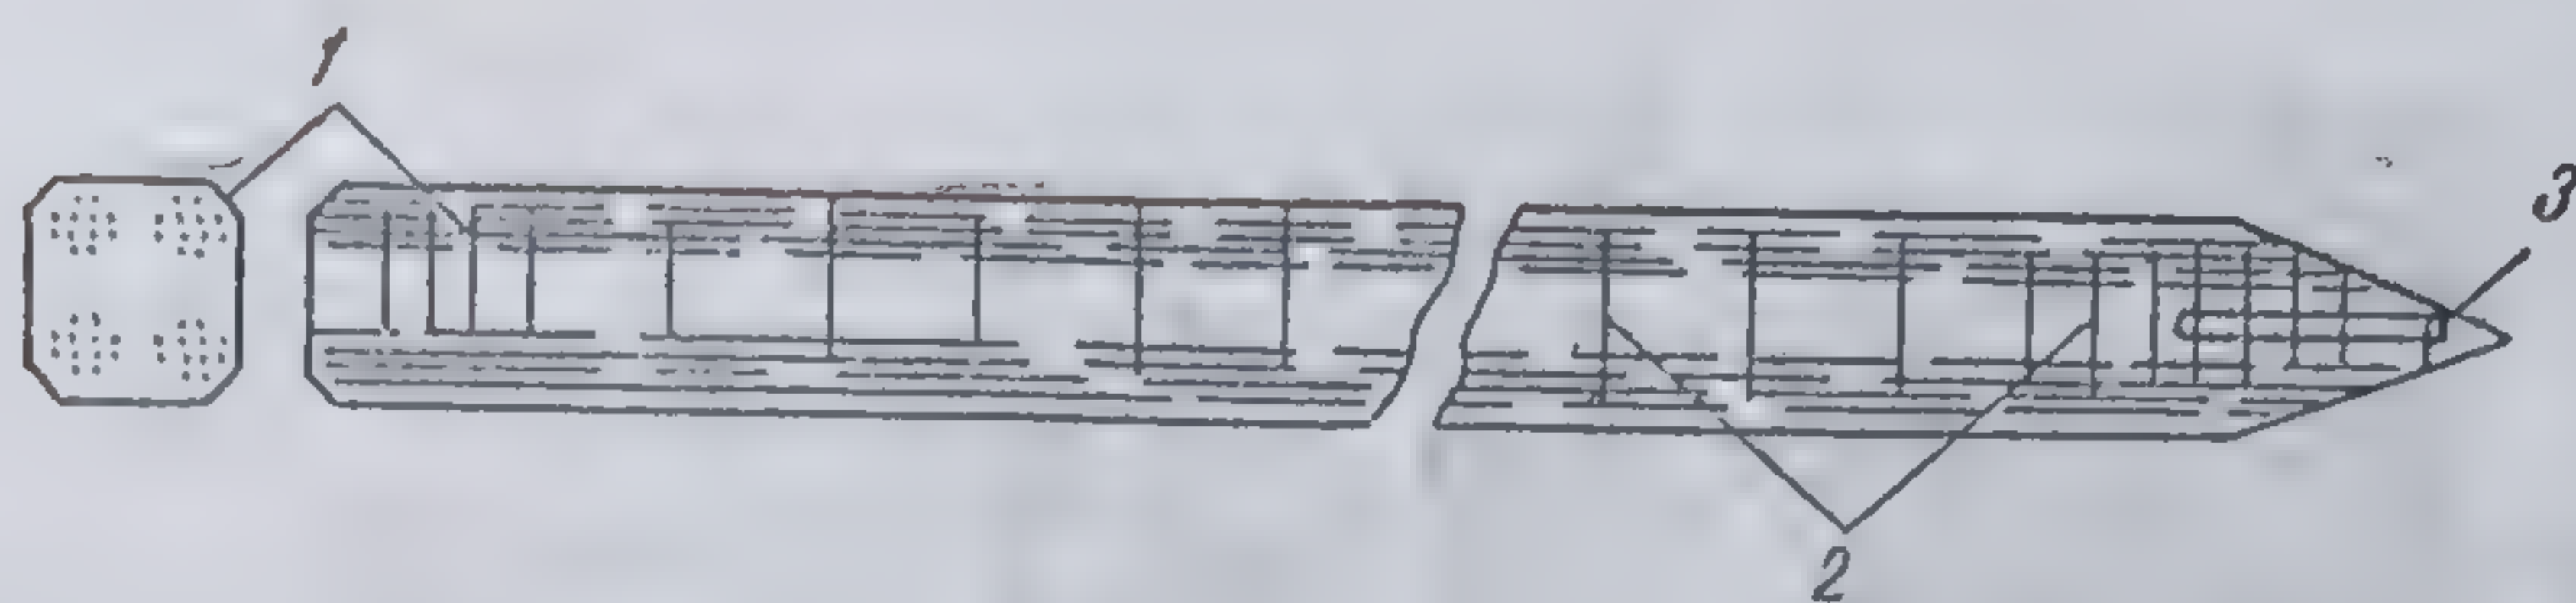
Alcătuirea obișnuită a unui pilot din beton precomprimat:
